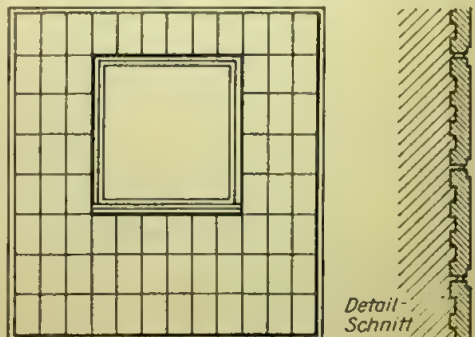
Außenwandelement mit Keramikverkleidung
